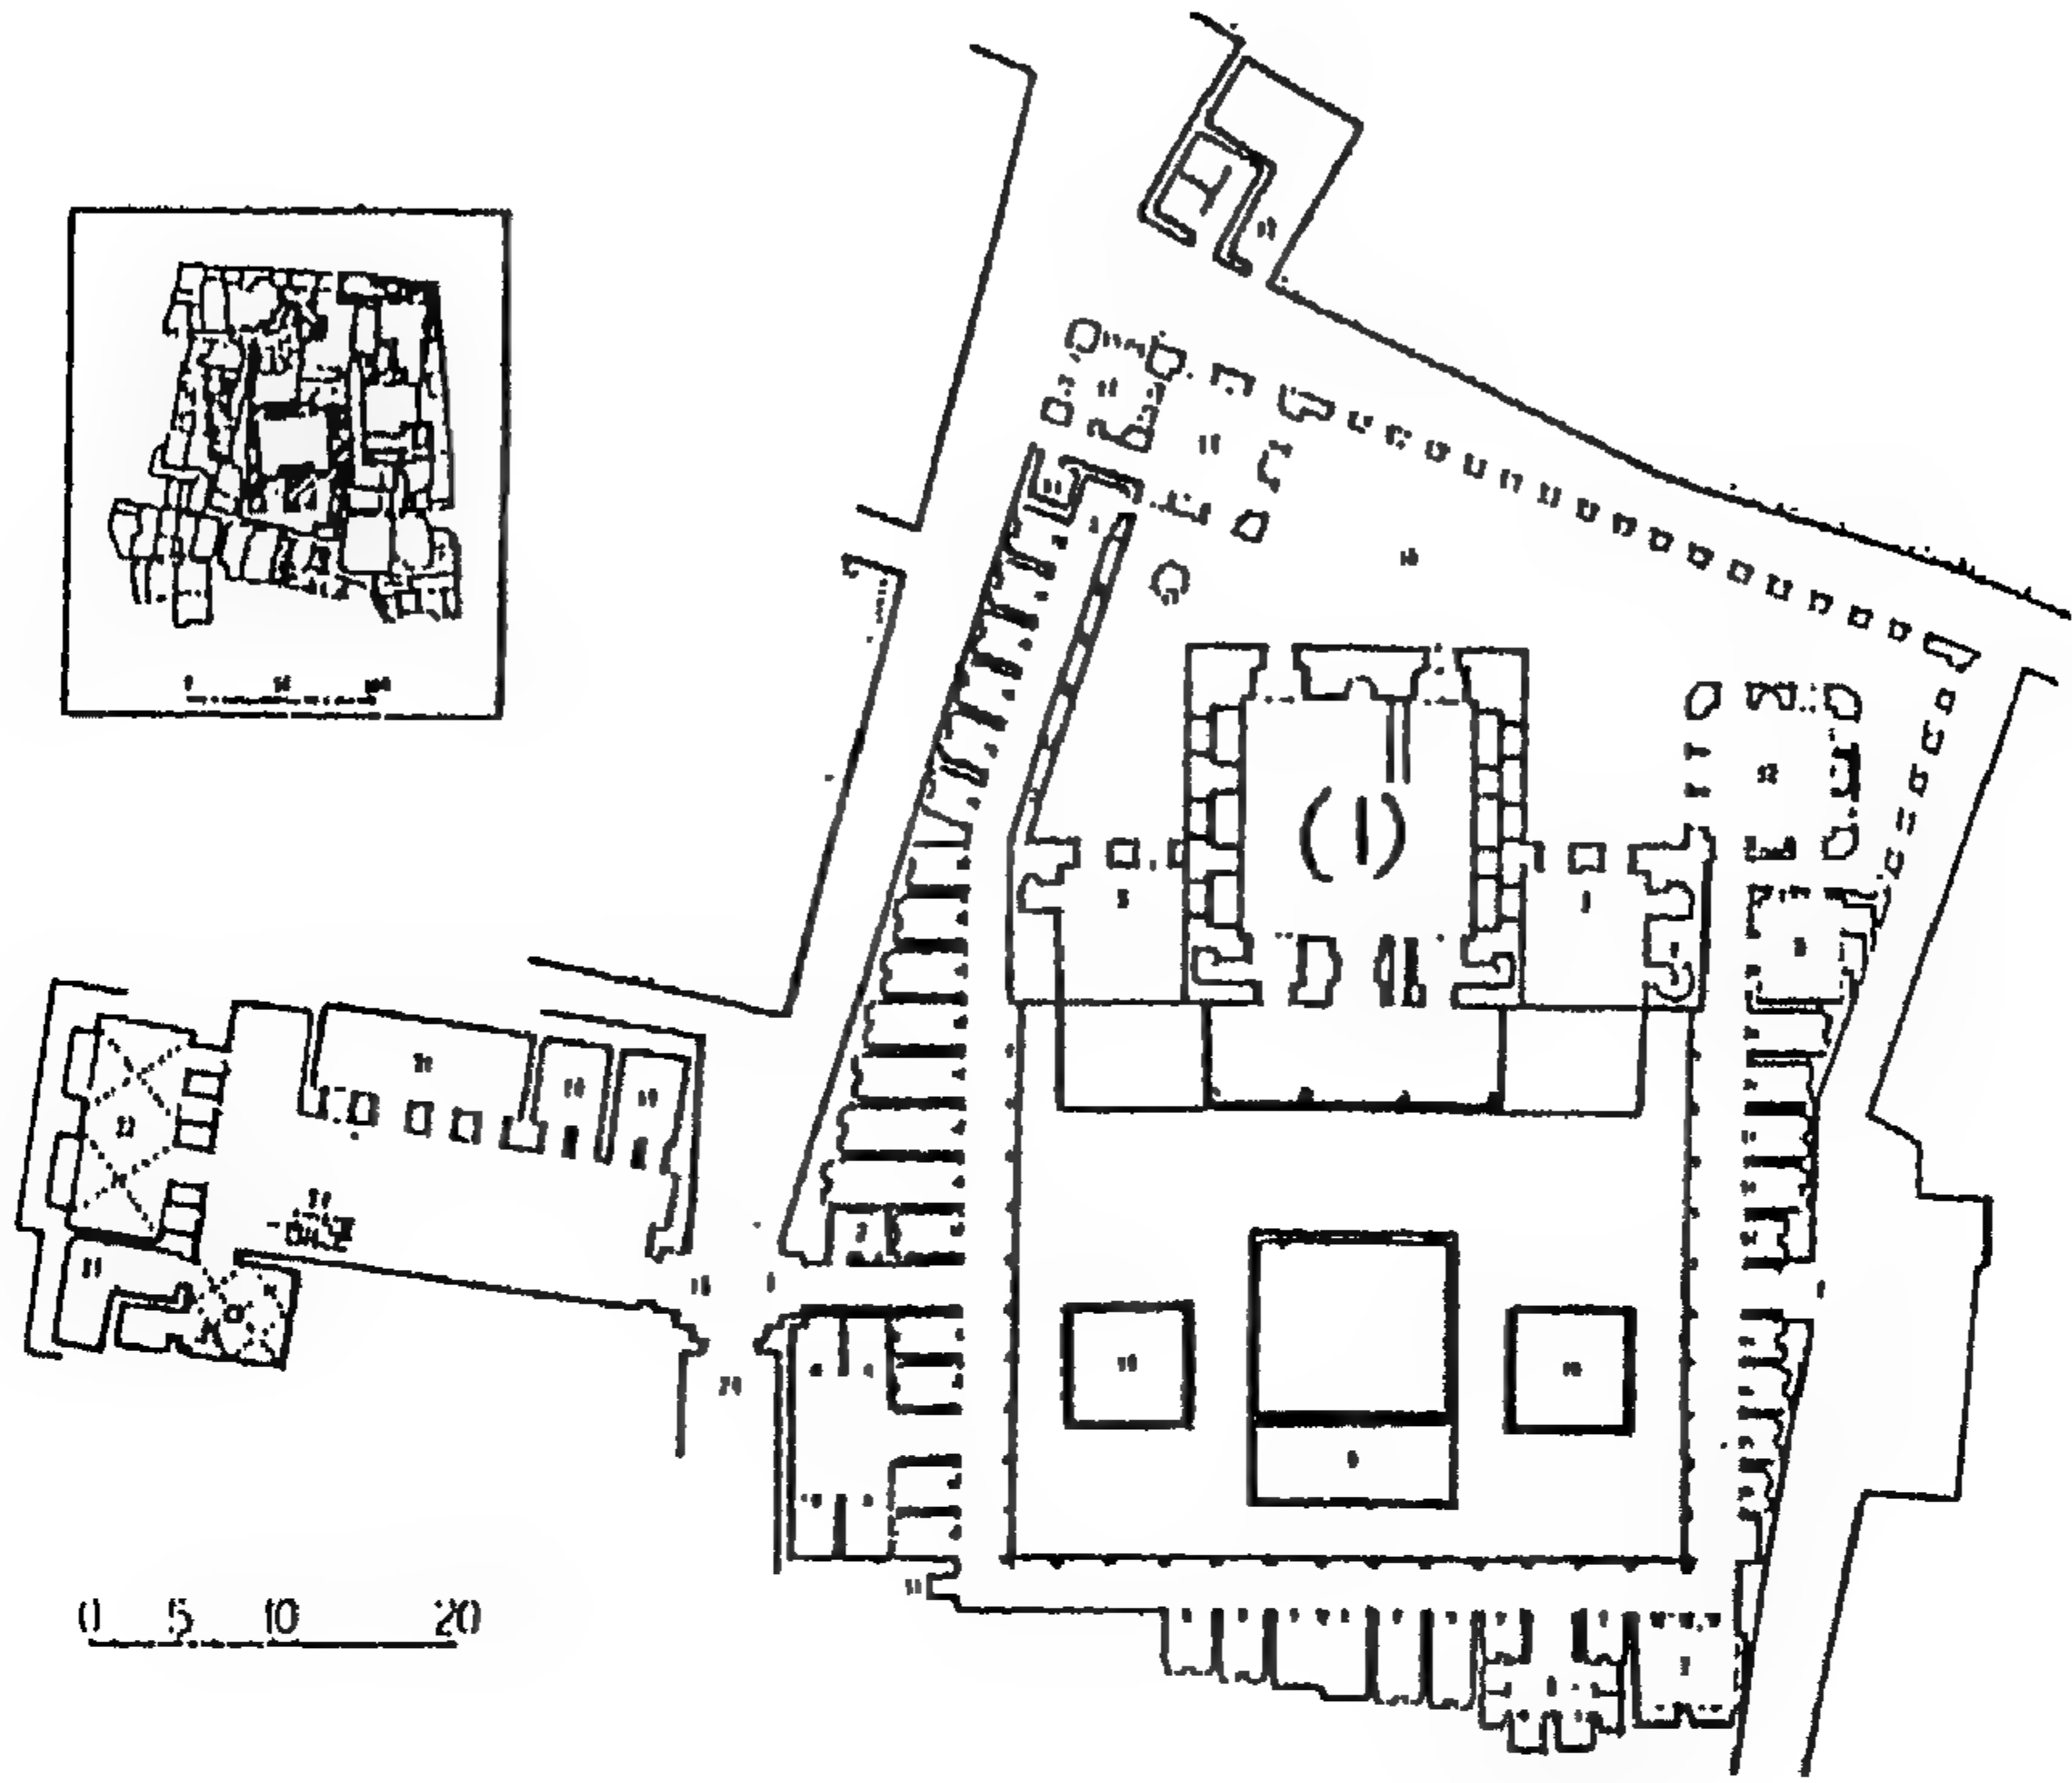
مسقط أفقي لمسجد قصر الحلابات . (عن كريزول) .
